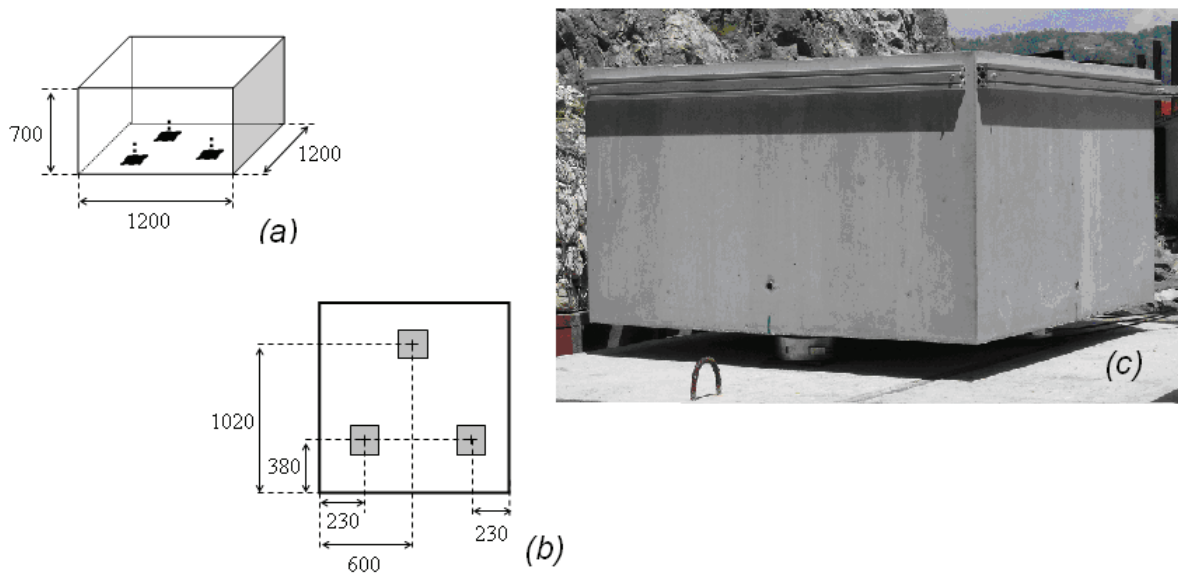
Socle: vue en perspective (a), vue de dessous (b) (dimensions en mm) et posé sur les capteurs de force (c).
